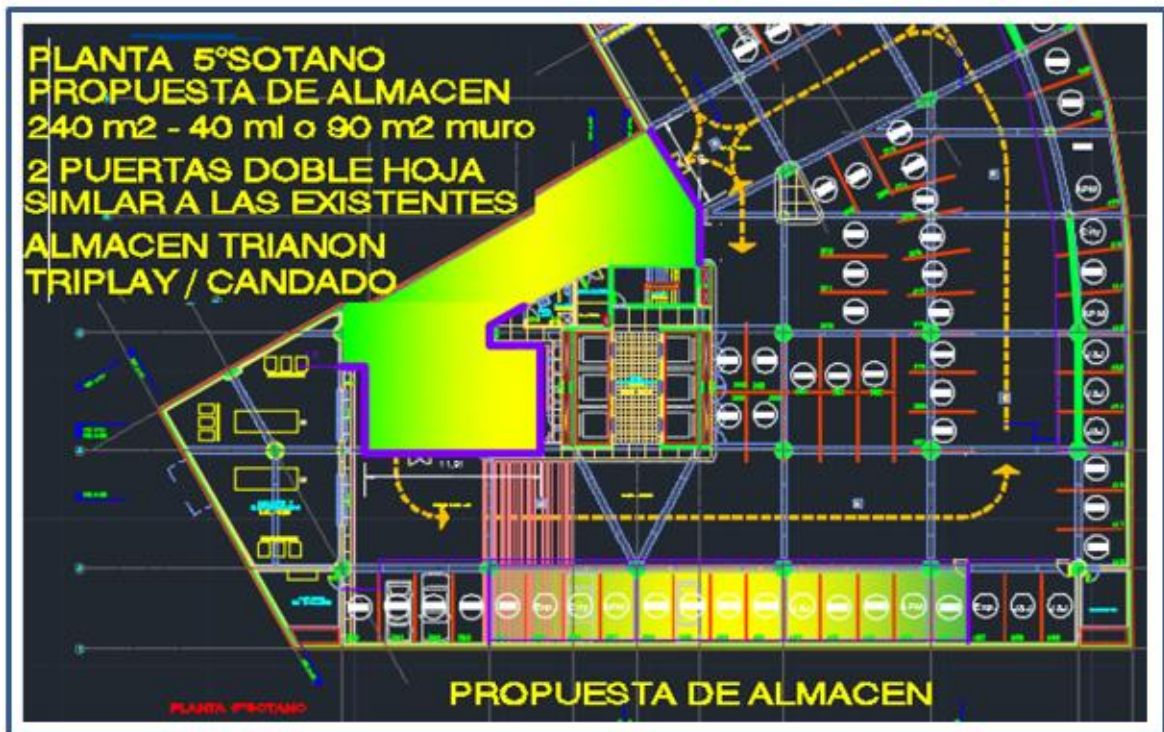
Plano en Planta de almacenes ubicados en los sótanos, nivel -5. Obra Chocavento, Inverdes S.A. Fuente Propia. (2017).
